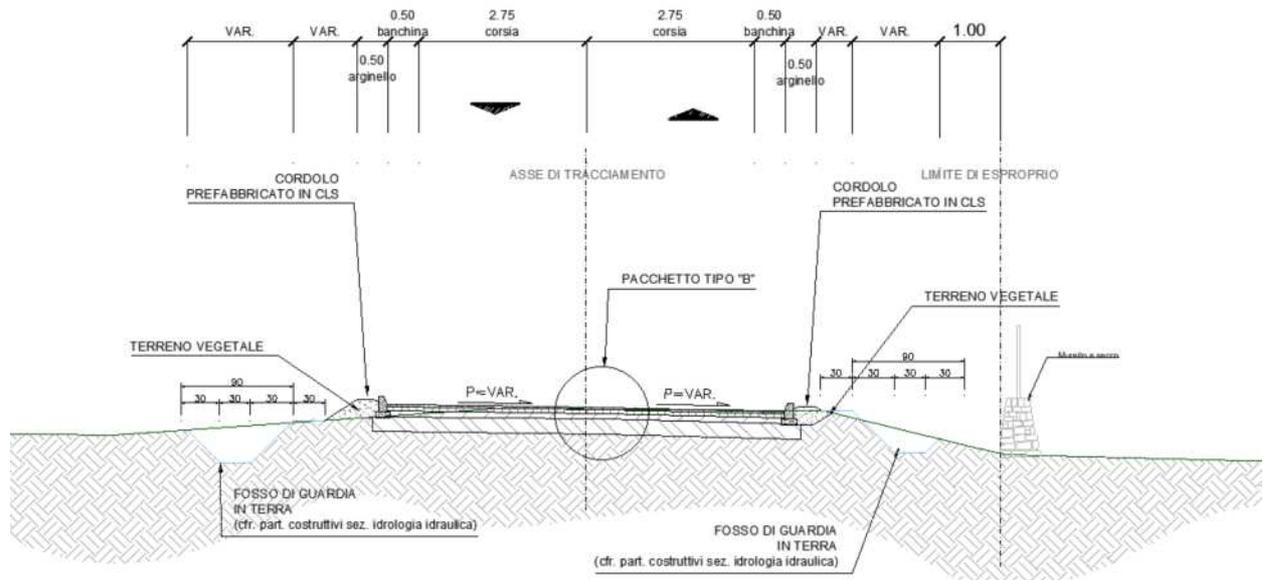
Sezione tipo Strada Vicinale San Pancrazio
